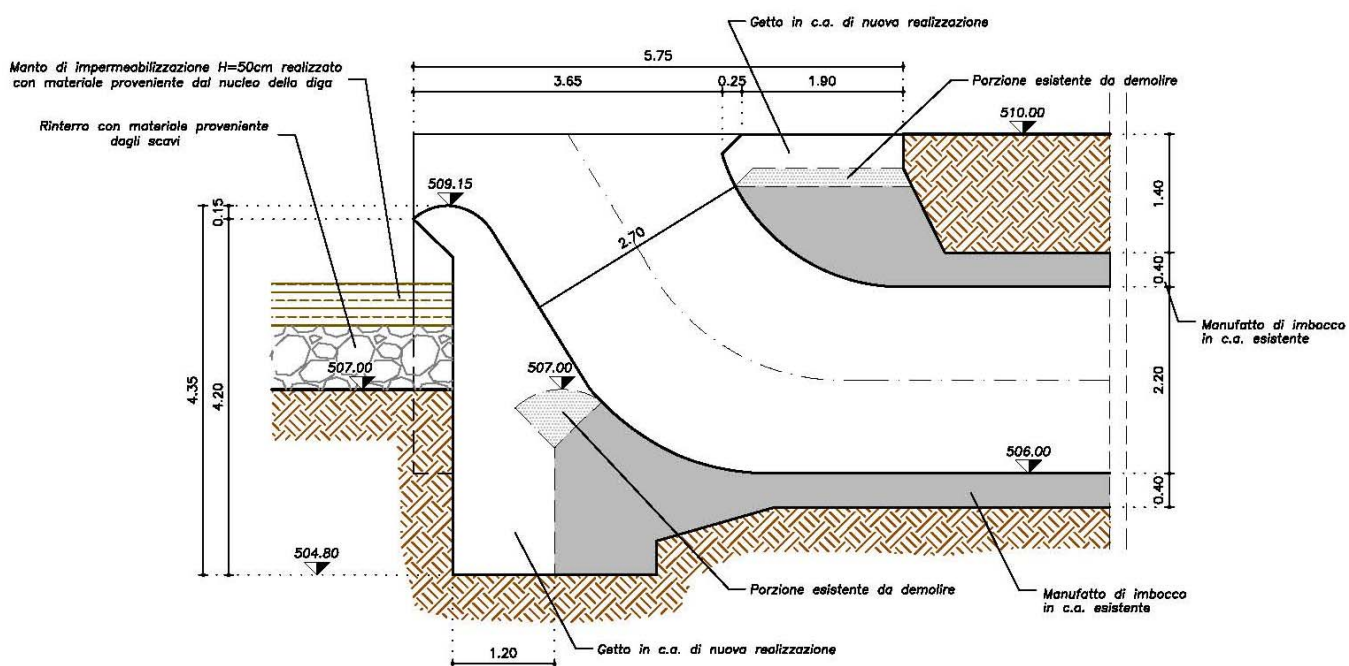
Sezione dell'imbocco dello scarico di fondo
